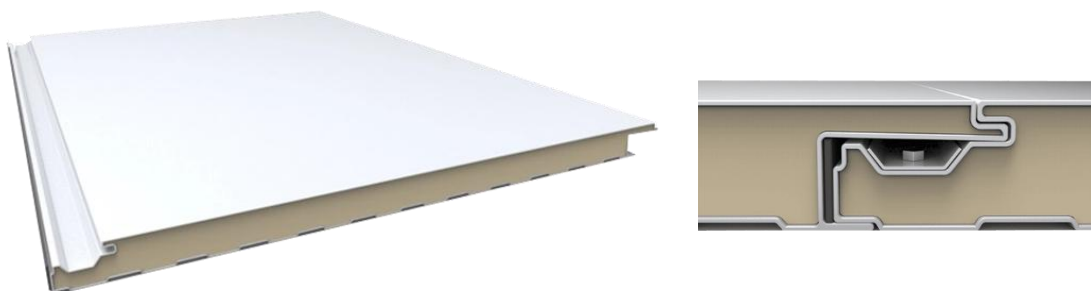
Panel sándwich de fachada arquitectónica y detalle de ensamble machihembrado. Fuente: Elaboración propia
